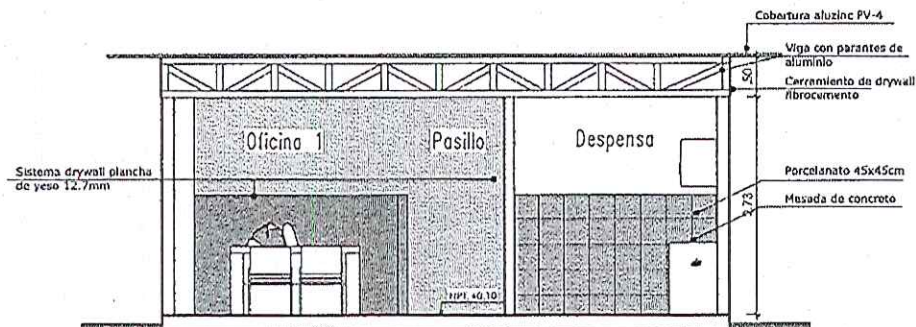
Corte Arquitectónico del acondicionamiento
